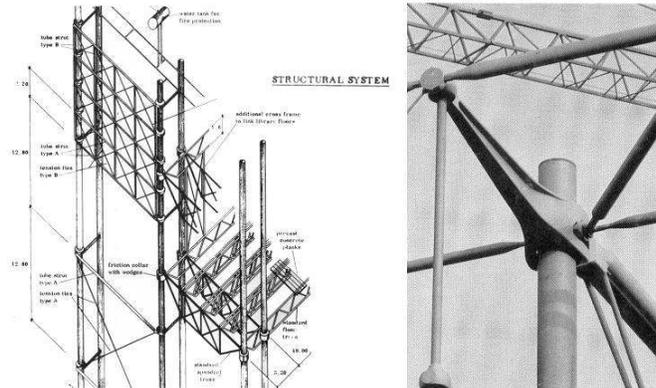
Estructura de acero laminado planteada por Arup para el concurso del Pompidou y detalle de la "gerberette" de hierro colado realizada por el Rice en colaboración con los arquitectos.
